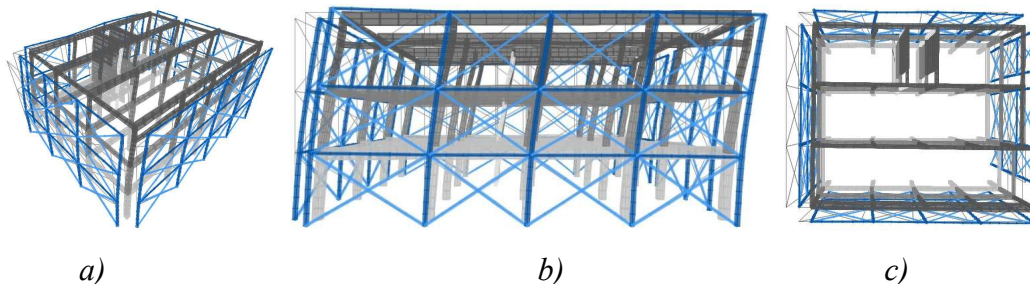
Deformate modali del primo modo di vibrare: a) vista prospettica 3D, b) vista prospettica frontale, c) vista prospettica dall'alto
